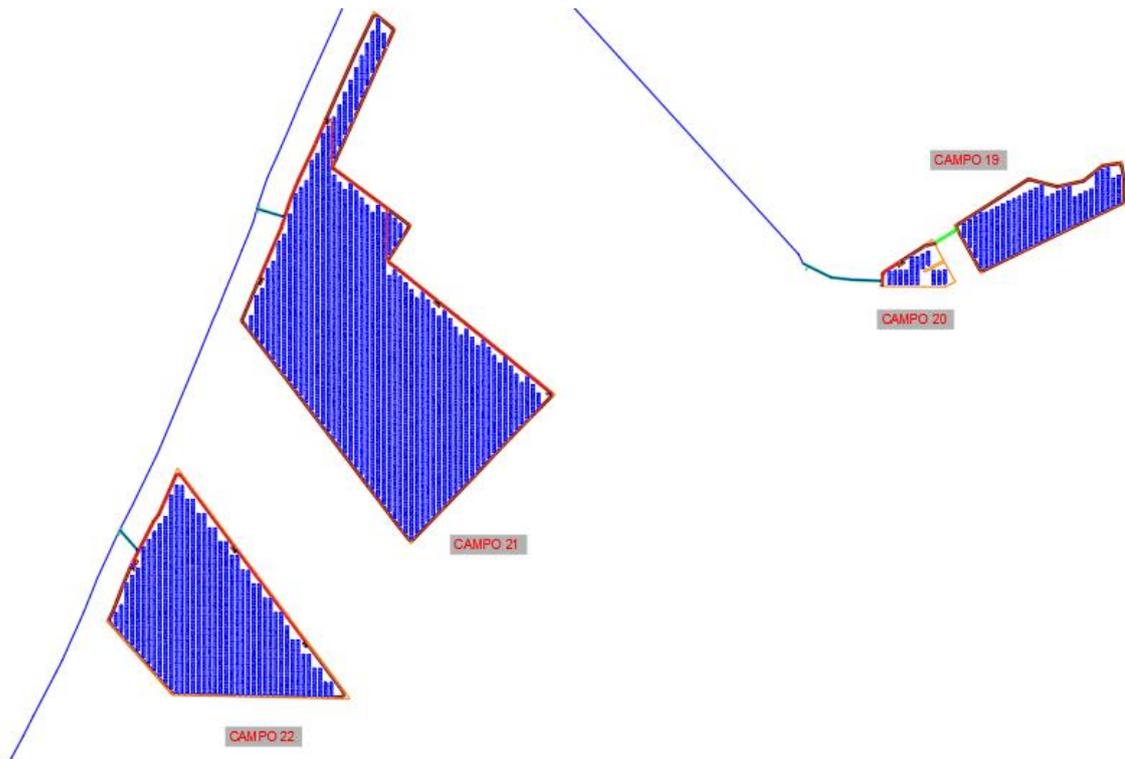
Schema layout dell'impianto – Vista Gruppo 2: da Campo 19 a Campo 22.
